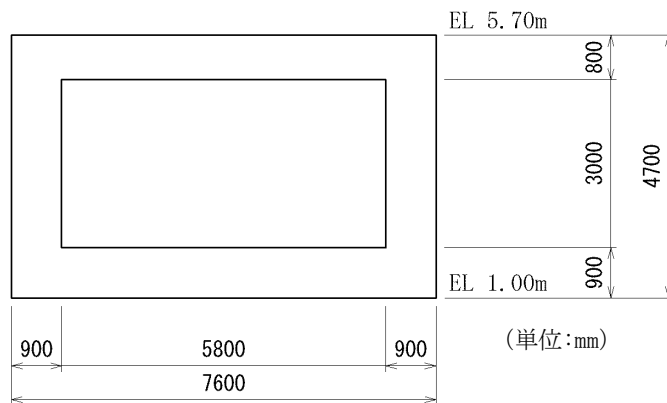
屋外配管ダクト (タービン建物～放水槽) 断面図 (C-C 断面)
